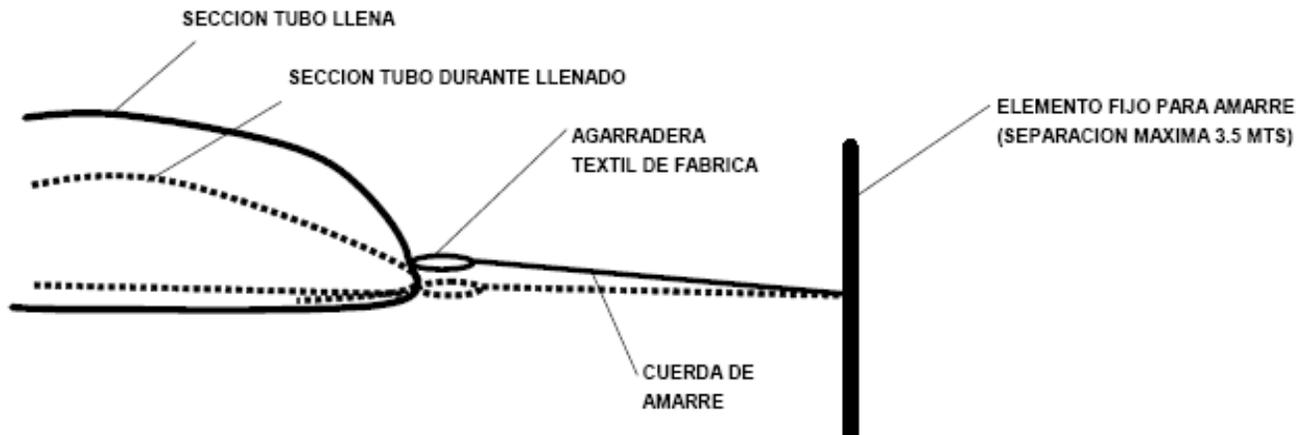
Fijación de tubo geotextil previo al llenado de arena.
